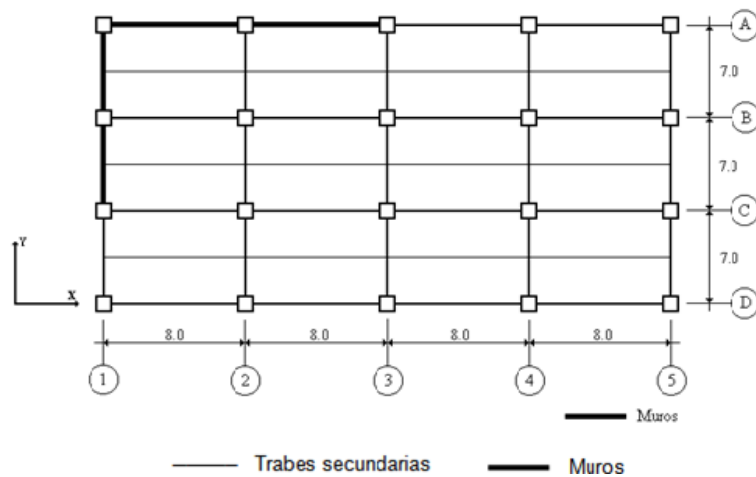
Planta tipo para el modelo de 15 niveles, modelo excéntrico en rigideces, 2 muros en cada dirección.
